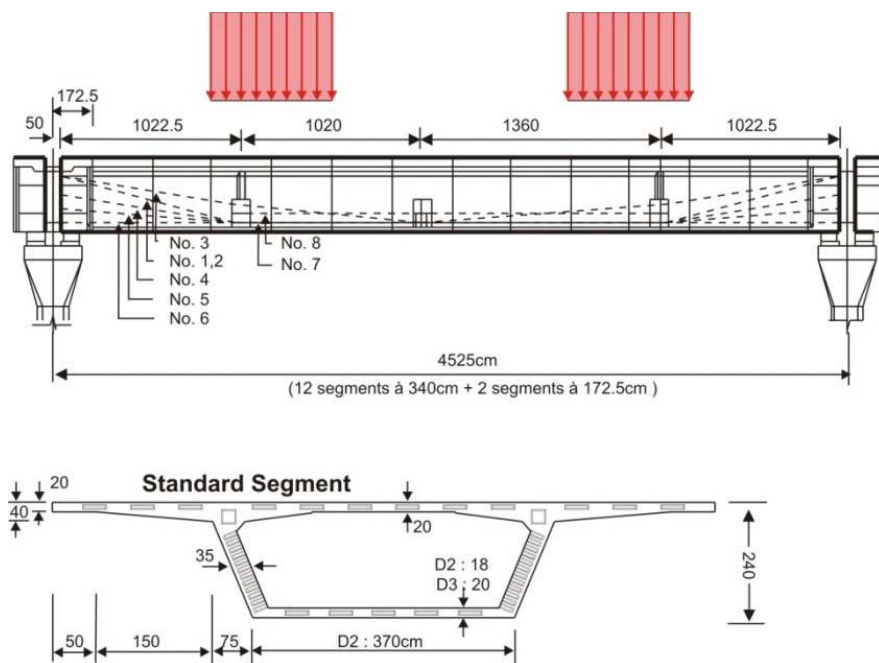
Vão de ensaio da "Second Stage Expressway System in Bangkok, Thailand".
